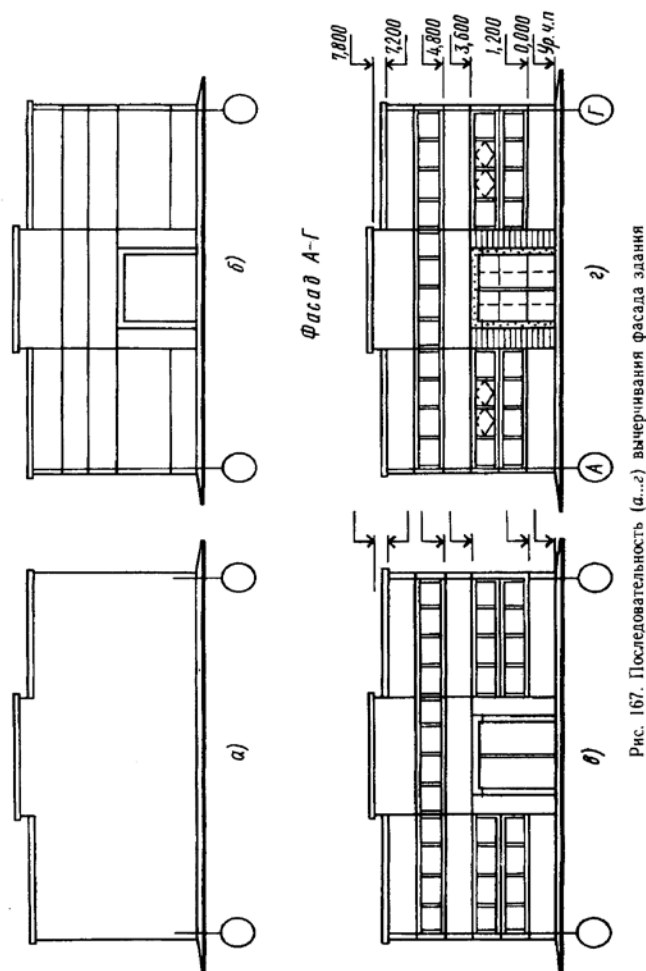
Последовательность (а...г) вычерчивания фасада здания
